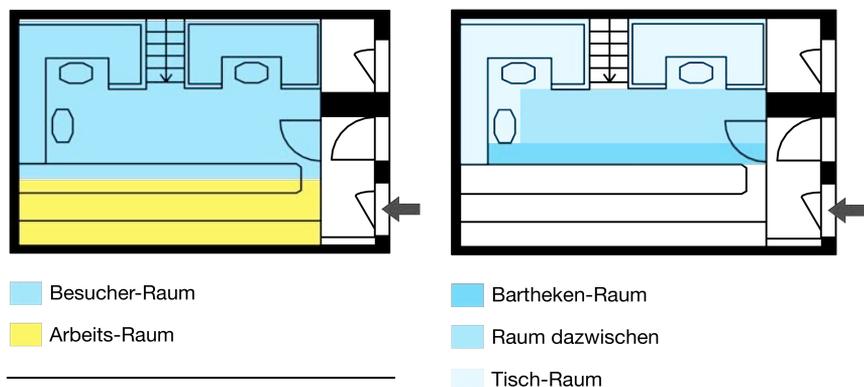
Loos Bar Grundrisse, Zeichnung: Nina Zurek
